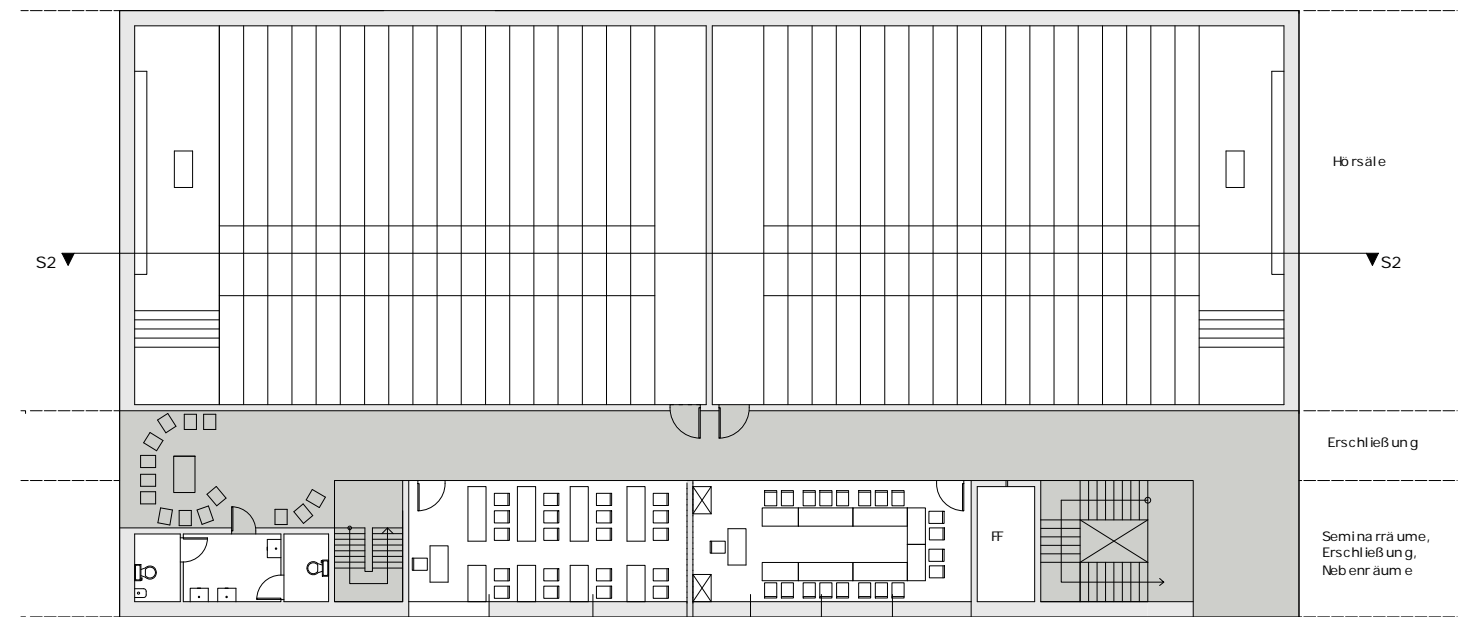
Auszug Lehre Grundriss Obere Hörsaalebene M= 1: 250
